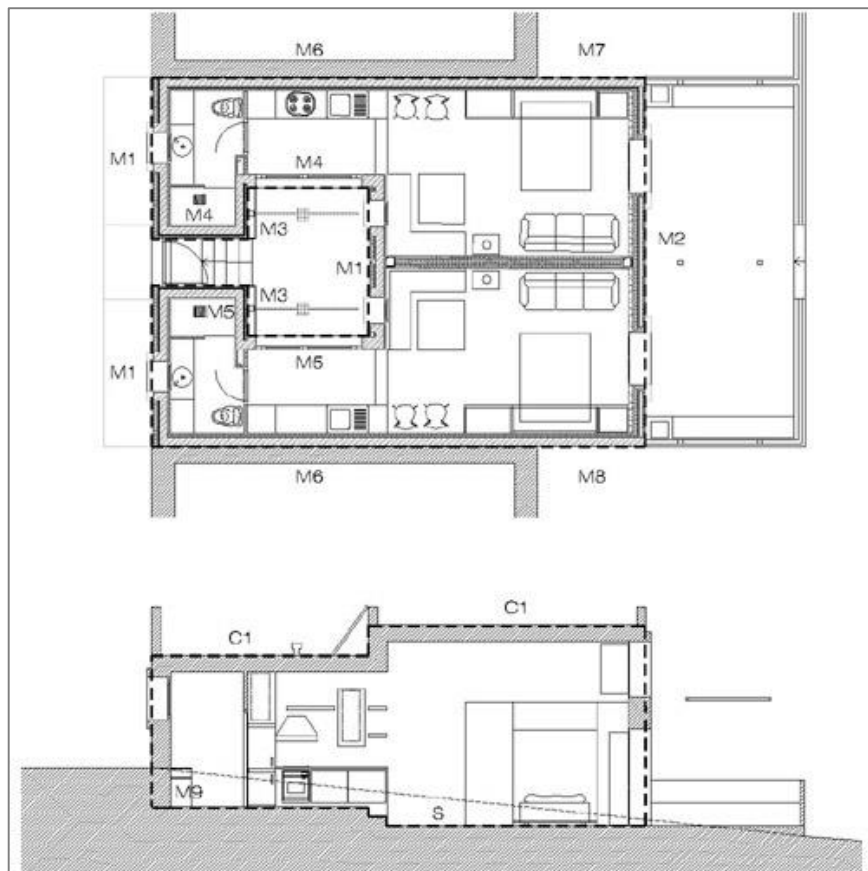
Vista en planta y corte - Rehabilitación Ecológica de una Vivienda en el cortijo Peiró – Artero - Almería – España
